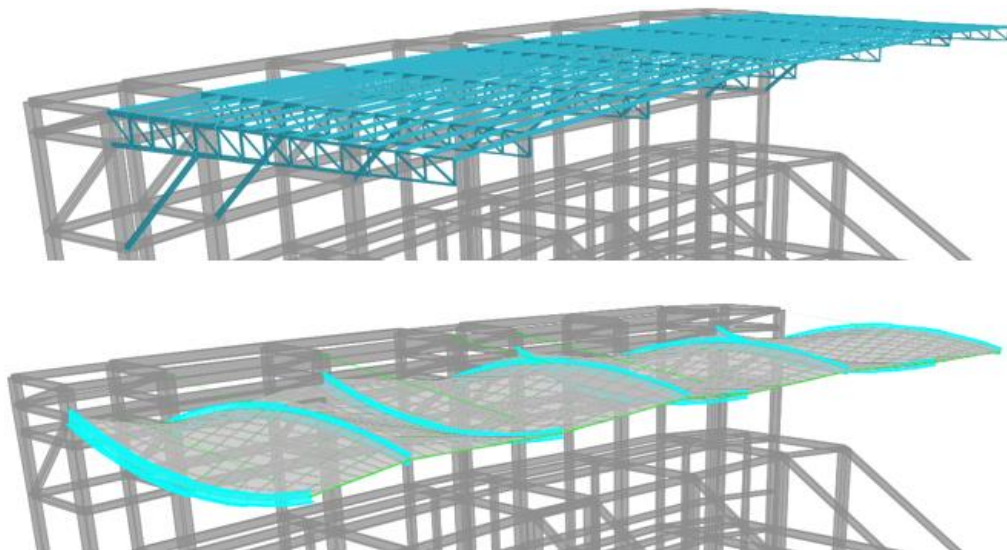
Vista en 3D del diseño de la Tenso estructura y la Cercha.
